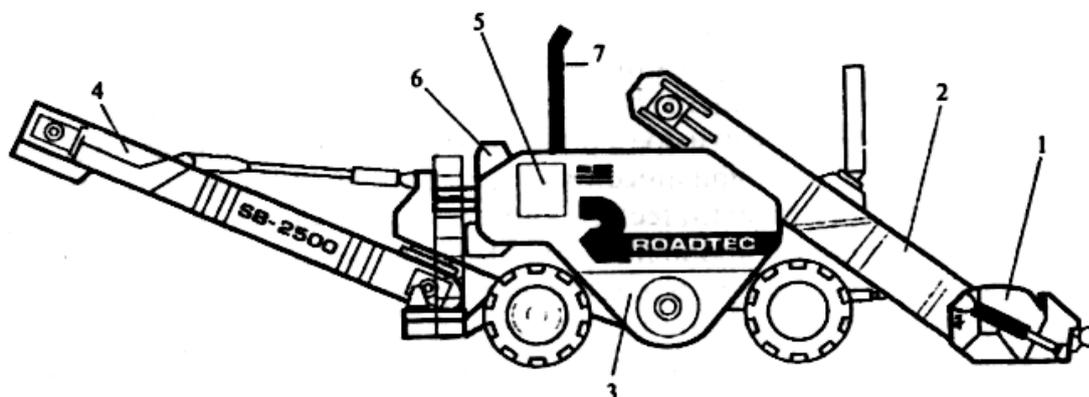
Конструктивная схема машины «Шаттл-Багги»: 1 — приемный ковш с перемешивающим шнеком; 2 — конвейер 907 т/ч; 3 — накопительный бункер 22,7 т; 4 — конвейер 544 т/ч; 5 — двигатель 276 л. с; 6 — пульт управления; 7 — выхлопная труба, складывающаяся при транспортировании
